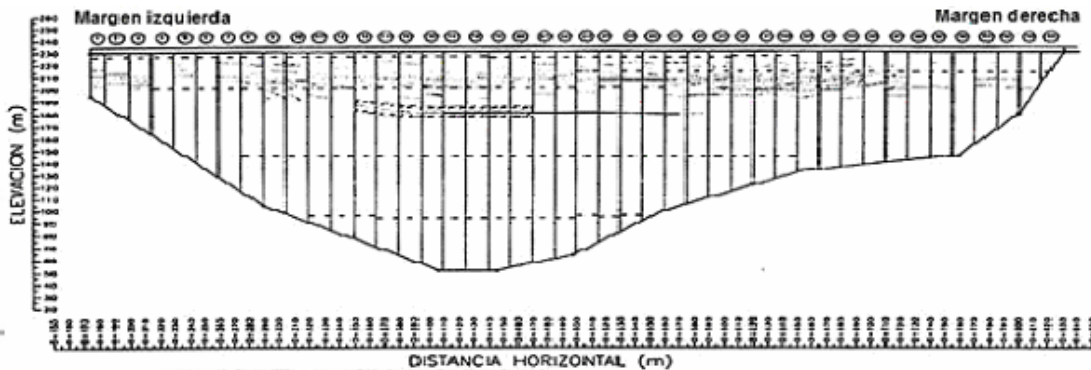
AGRIETAMIENTO DE LA CARA DE CONCRETO DE AGUAMILPA
